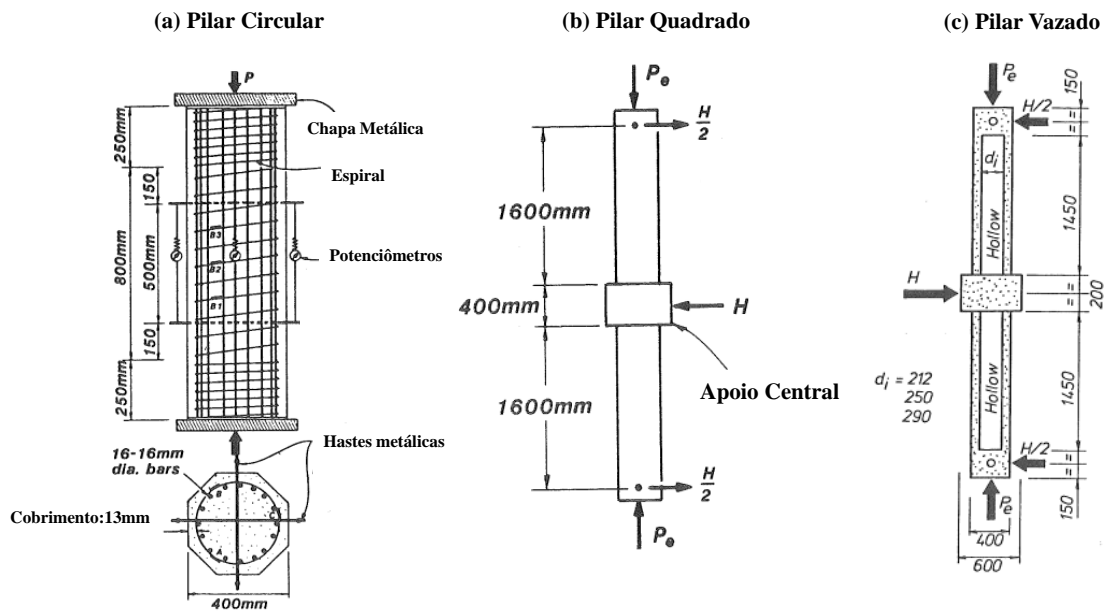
Detalhes dos pilares ensaiados por Zanh (Fonte: Zanh, 1984)
